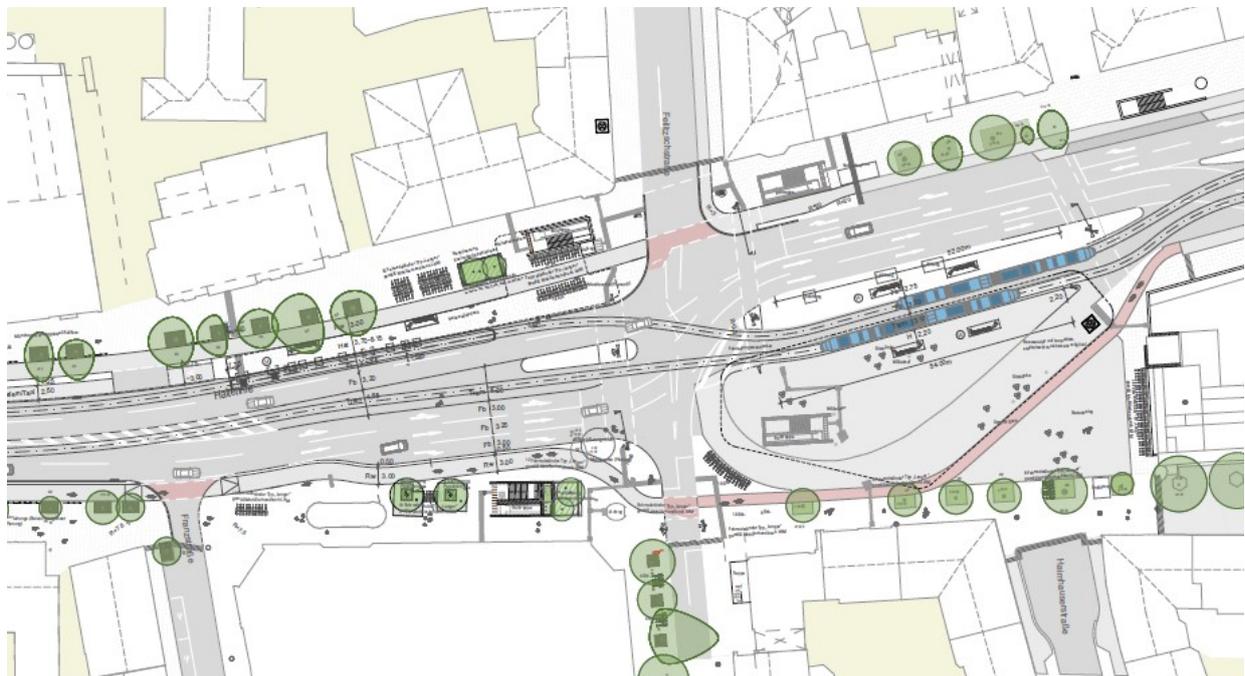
Lageplan V3 (Quelle: SWM/MVG, mgk Landschaftsarchitekten)
